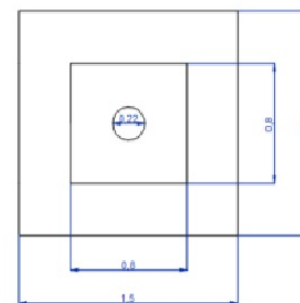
Vista en planta de postes 2, 3, 4, 5, 6, 7, 8 y 9
